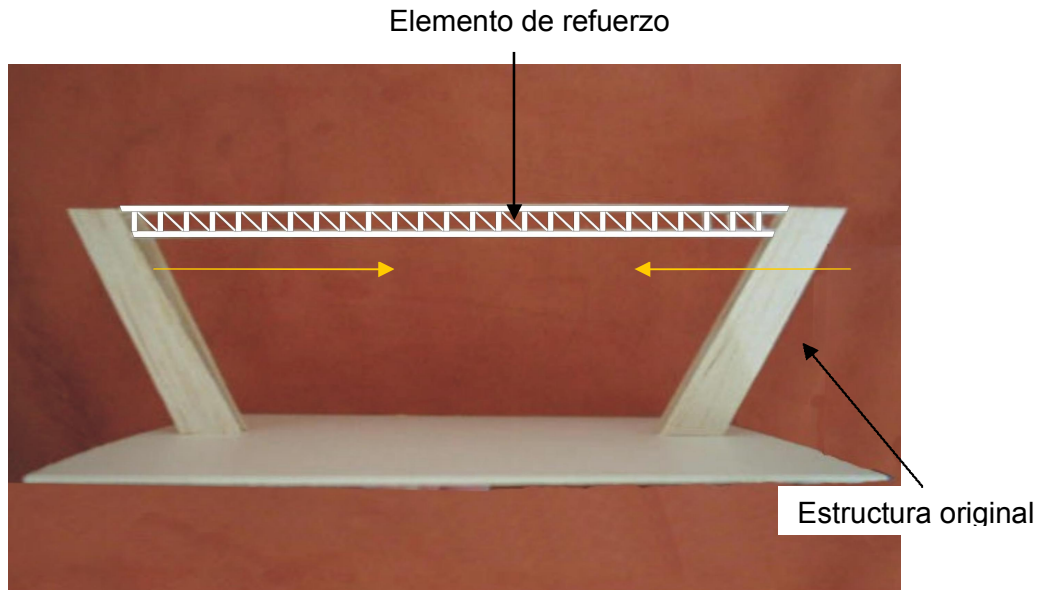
Las líneas amarillas muestran la dirección en que ejerce su fuerza el elemento estructural de refuerzo.
